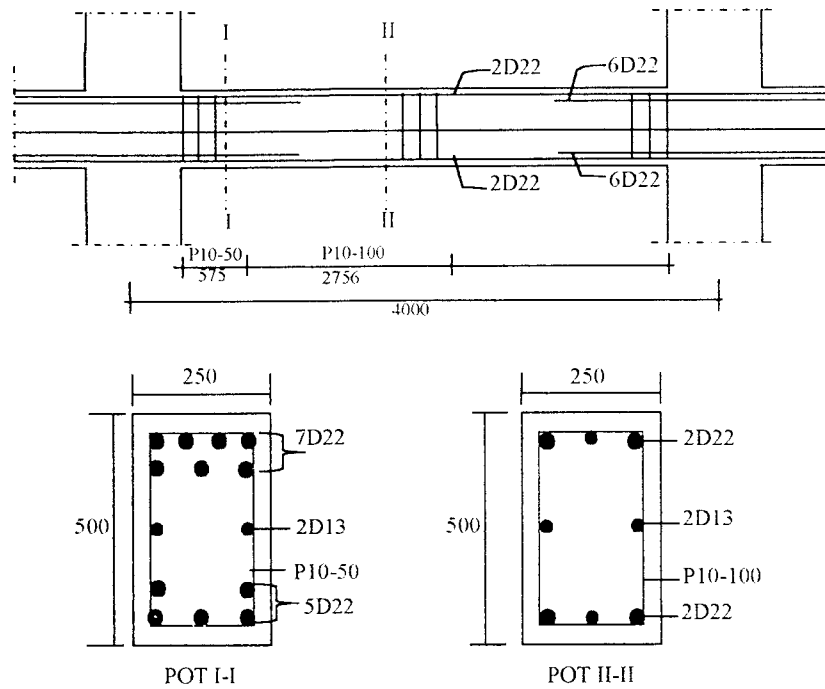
Balok Portal E Bentang 4 m Lantai 3
